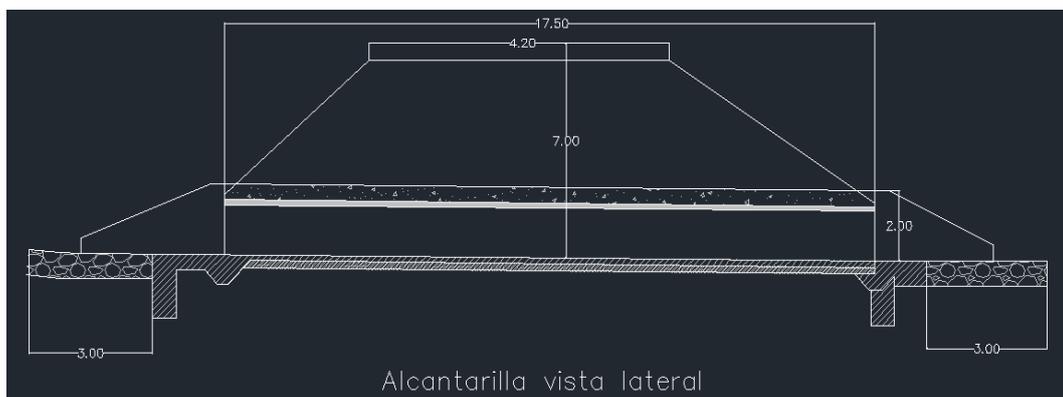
DETALLES DE PROTECCION DE UNA ALCANTARILLA
